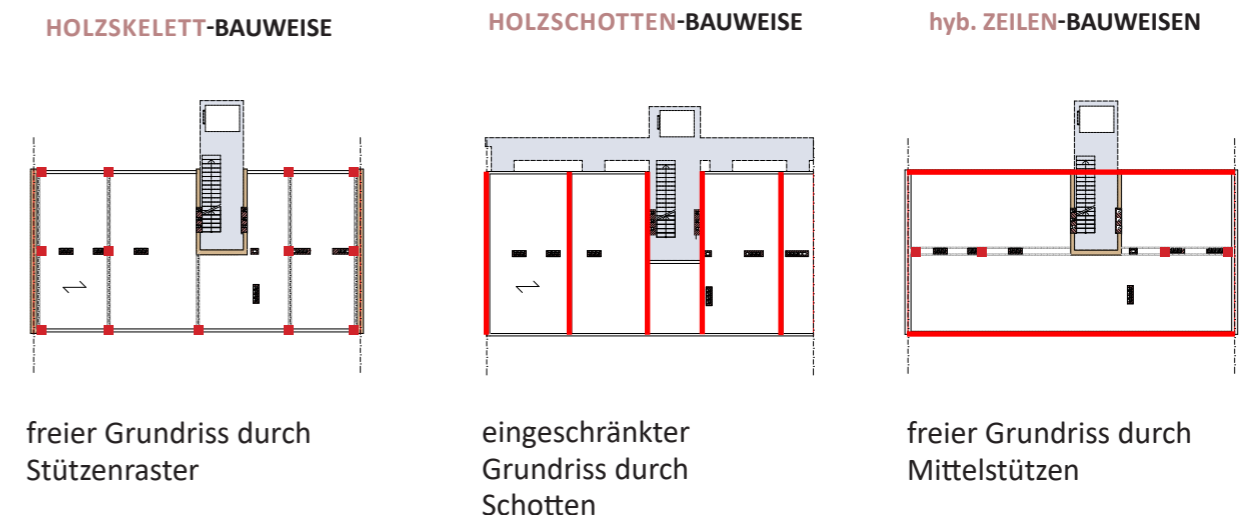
schematische Grundrissdarstellung aller drei Bauweisen
